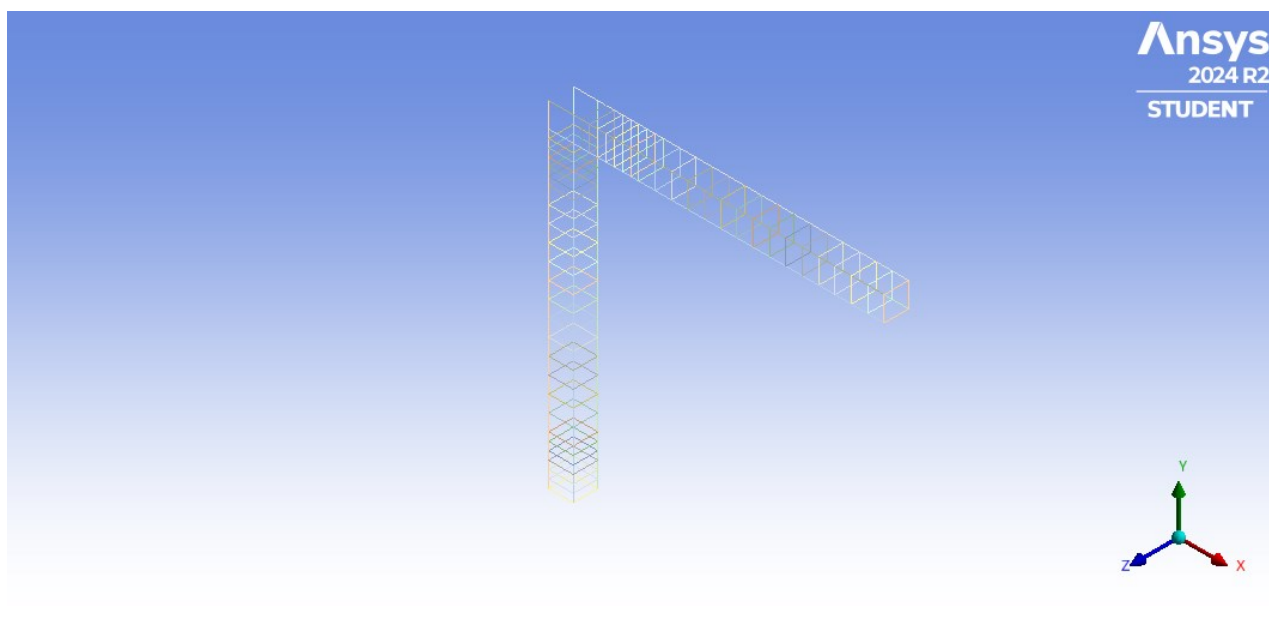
Vista assonometrica delle barre longitudinali e staffe (linee)
